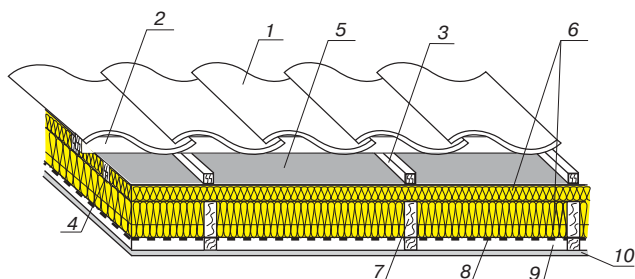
Схема устройства теплоизоляции со стропилами в теплой зоне: 1 – кровельное покрытие; 2, 3, 4 – контробрешетка; 5 – гидроизоляционная паропроницаемая мембрана Tyvek Soft; 6 – теплоизоляция ISOVER СкатнаяКровля; 7 – стропила; 8 – пароизоляция; 9 – воздушный зазор; 10 – внутренняя отделка мансарды
